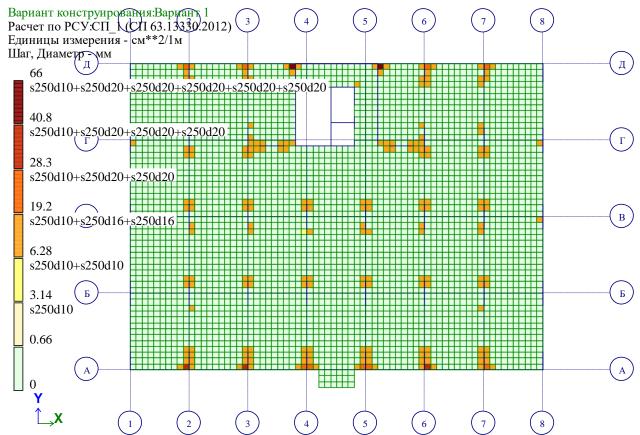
Расчетное армирование плиты над подвалом по оси X у верхней грани.
